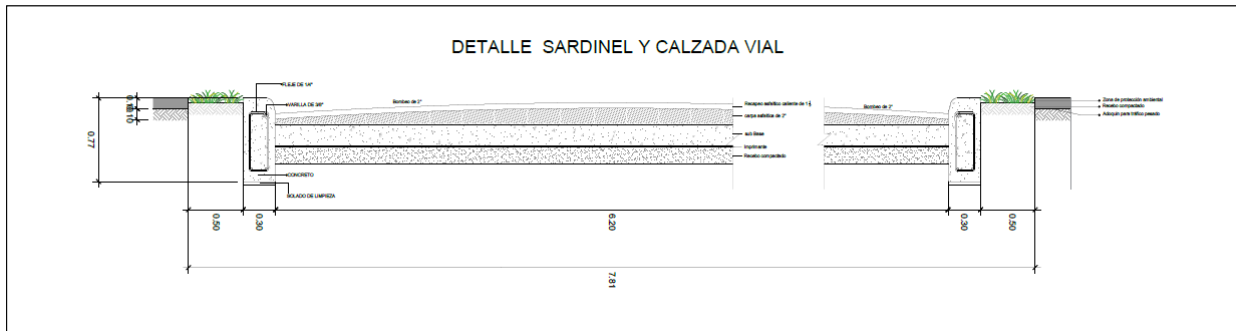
, Detalle constructivo del sardinel y la calzada vial.
